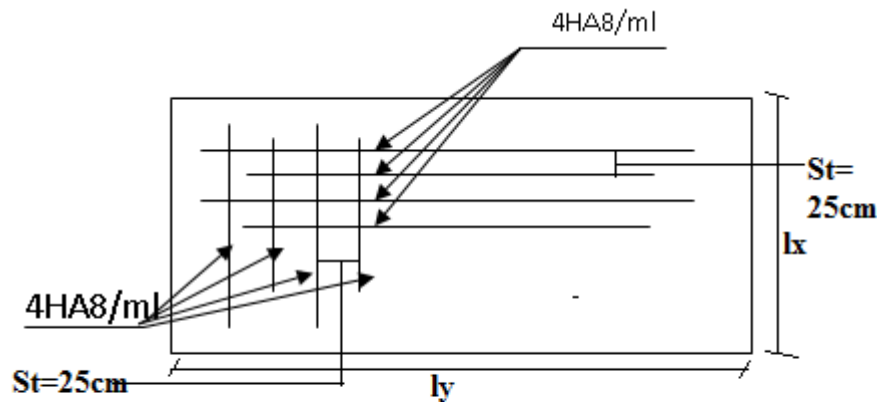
schéma de ferrailage de la dalle plane sur deux appuis.
